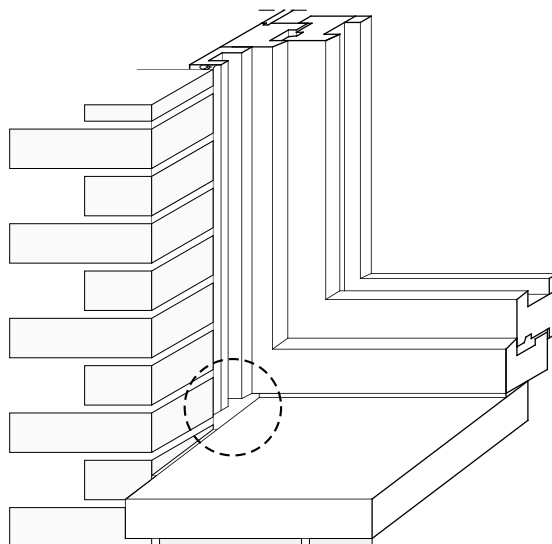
Manque d'étanchéité au niveau des rails de guidage, dû au placement d'une pierre de taille entre tableaux.
